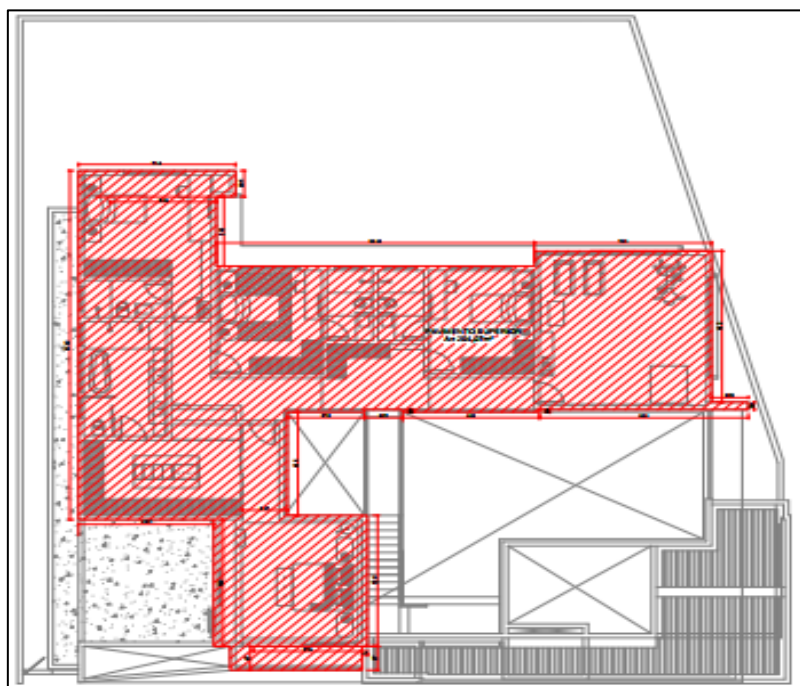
Projeto arquitetônico obra 2: pavimento térreo
